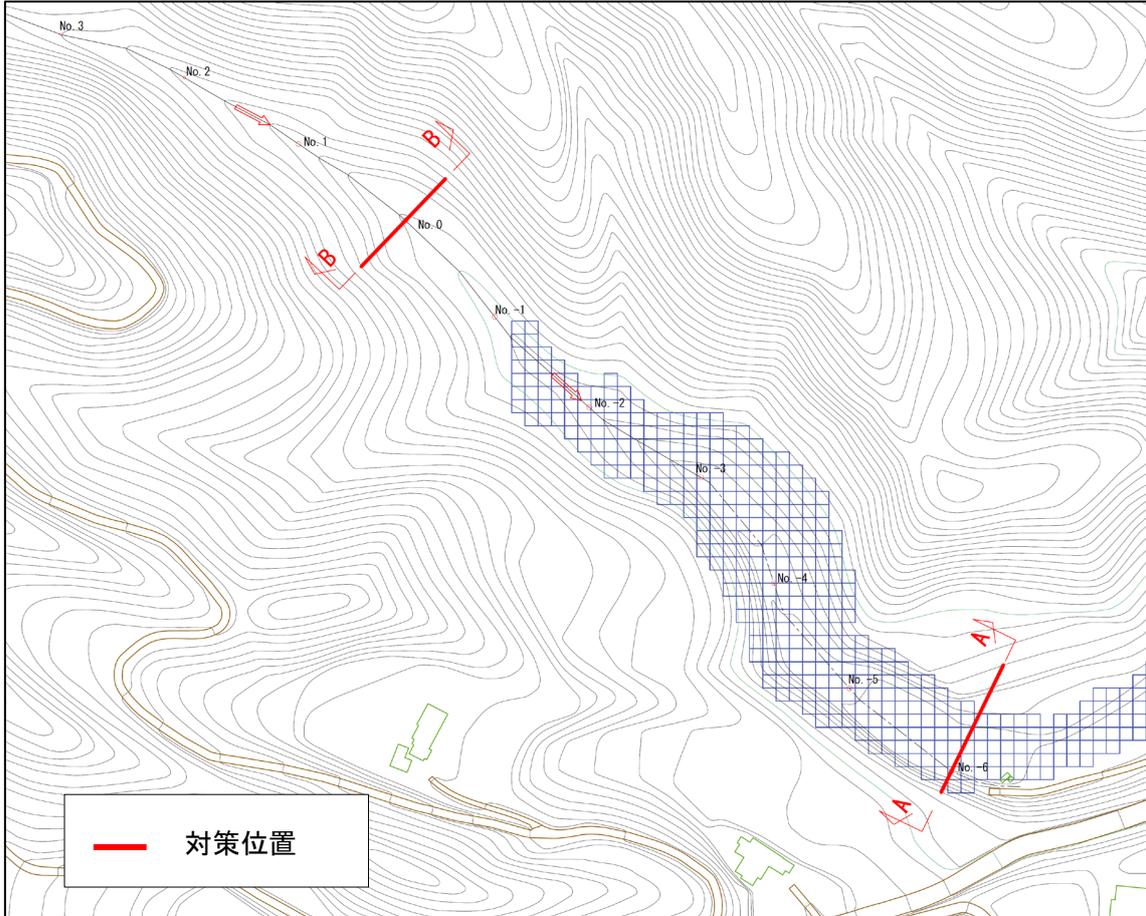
仮設堰堤工（コンクリートブロック）の配置例（参考）；3-D012（平面図）
